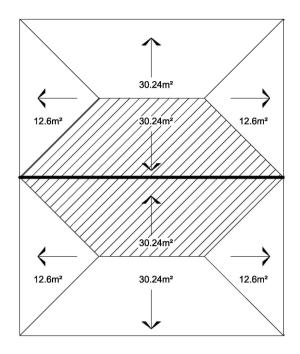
Análisis de losa tipo A, para calculo de vigas de acero.
